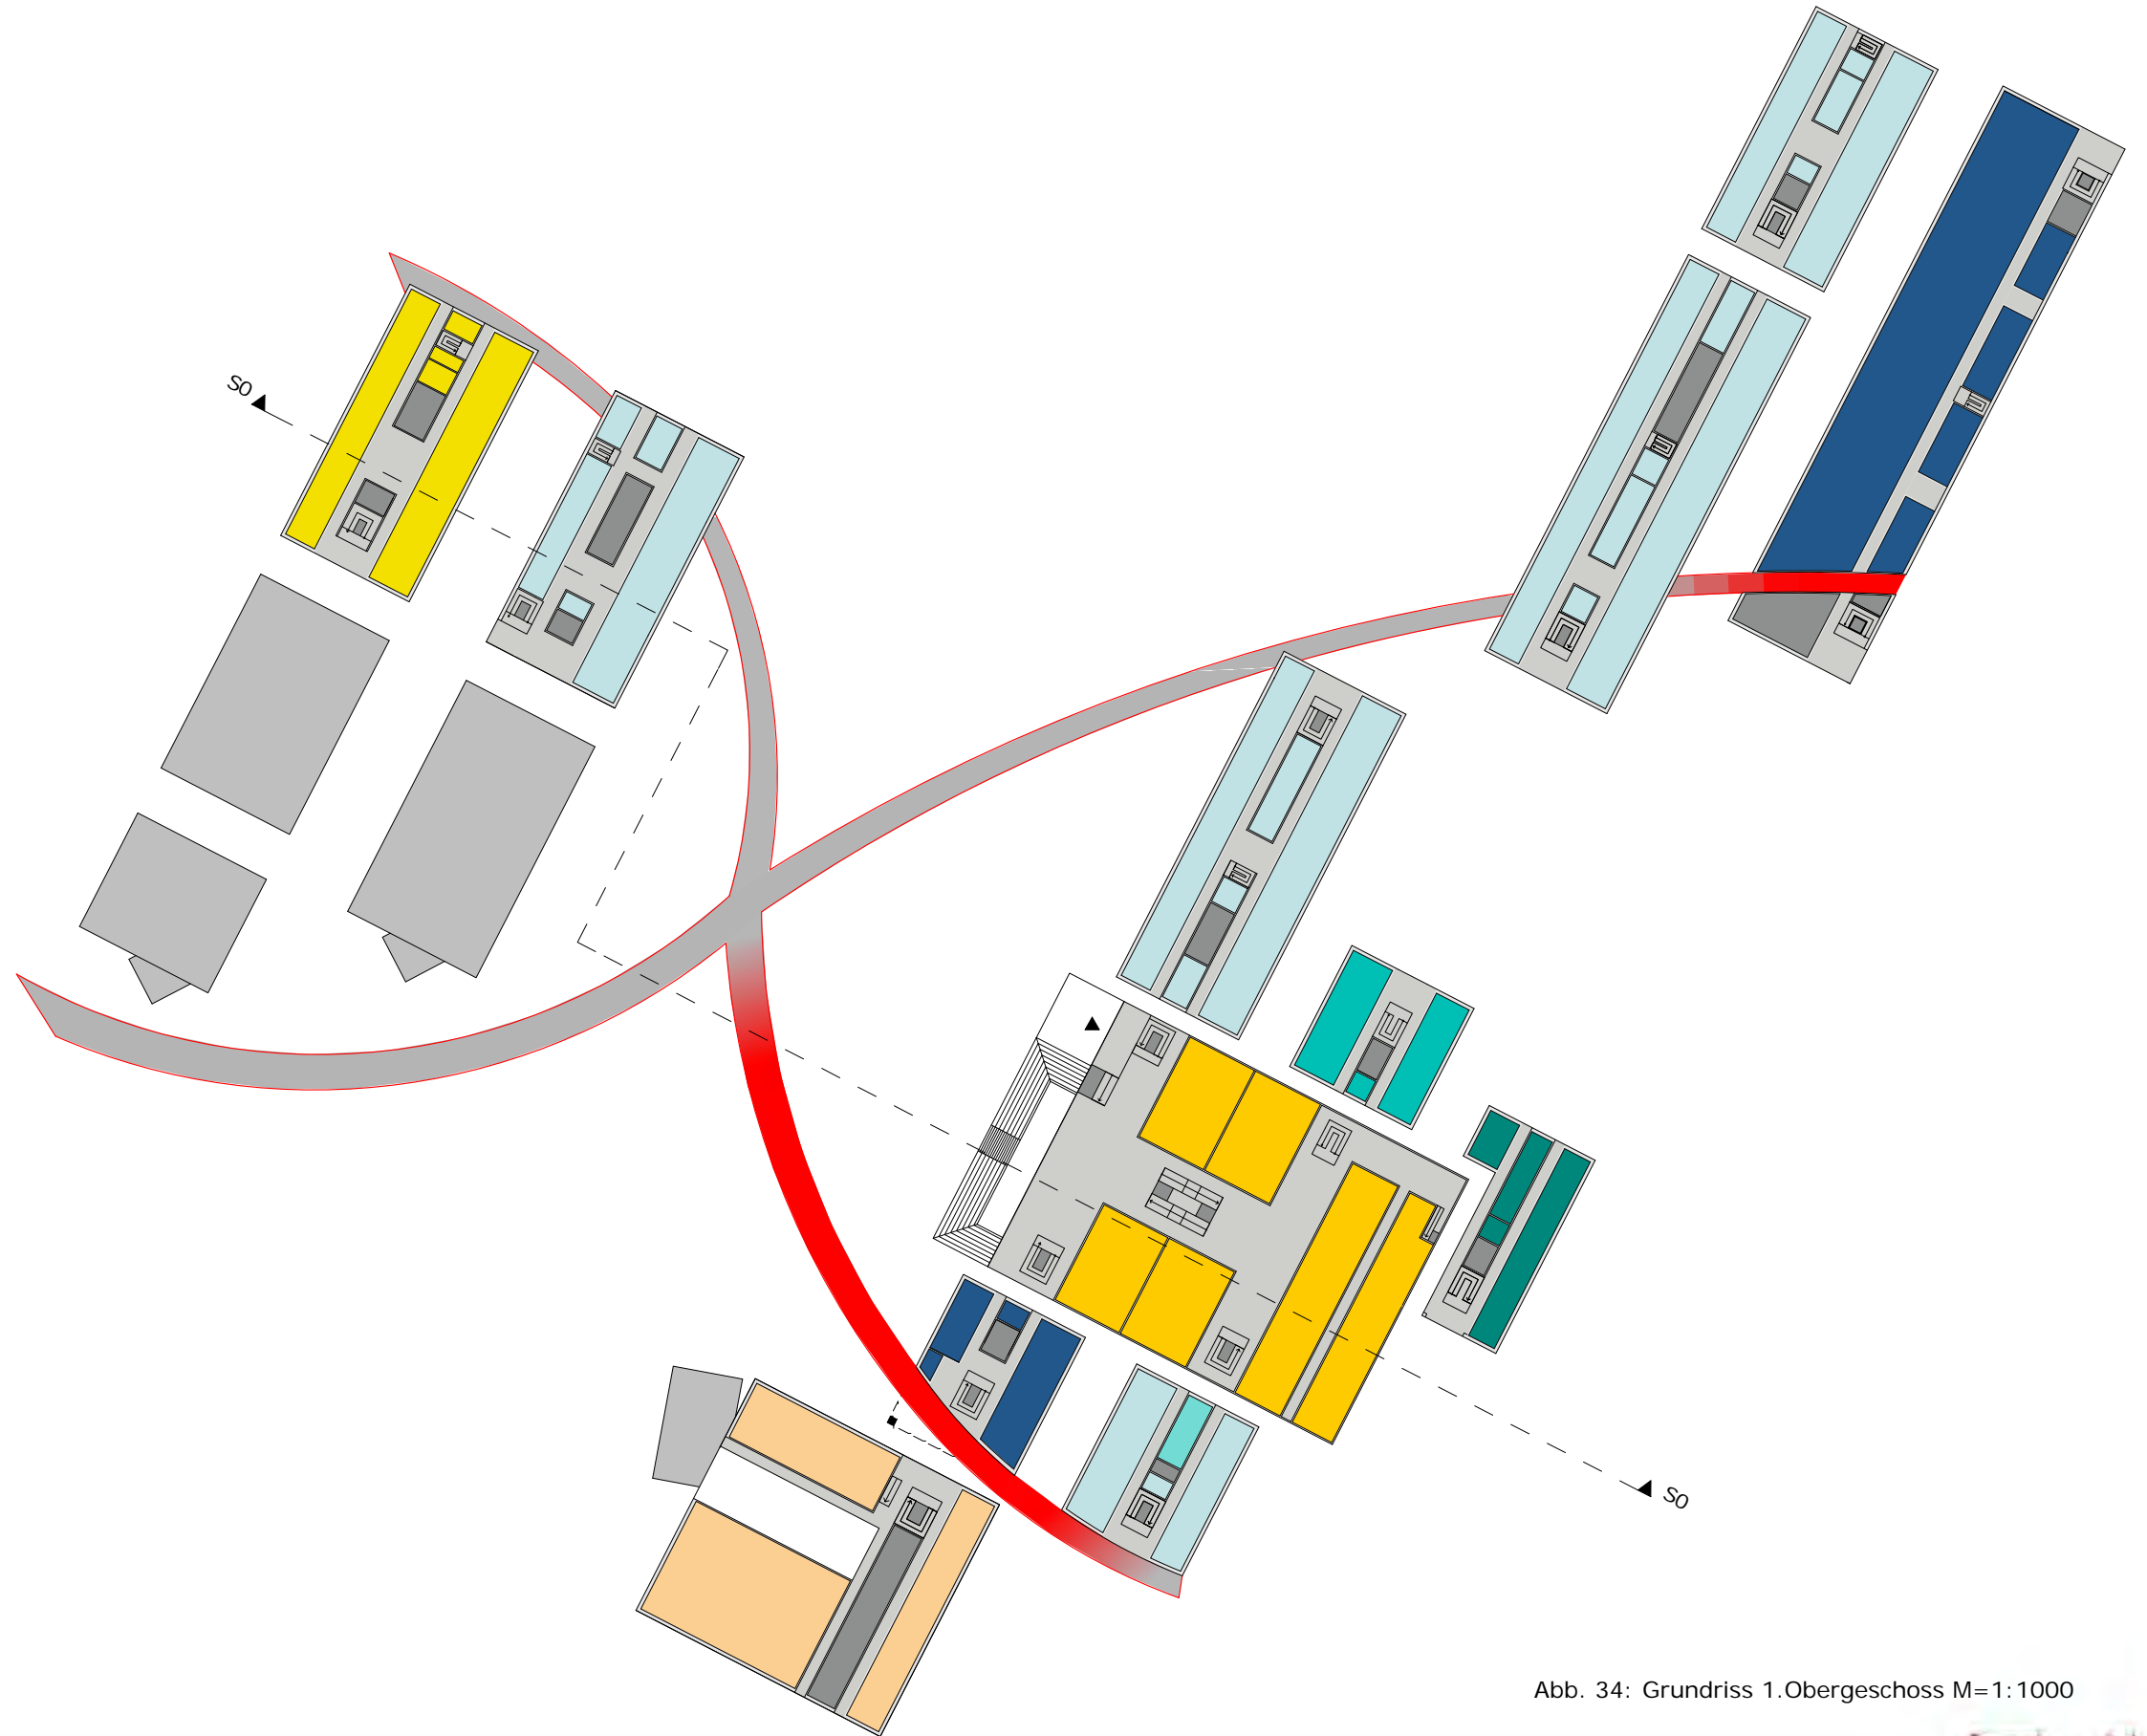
Grundriss 1.Obergeschoss M=1:1000
